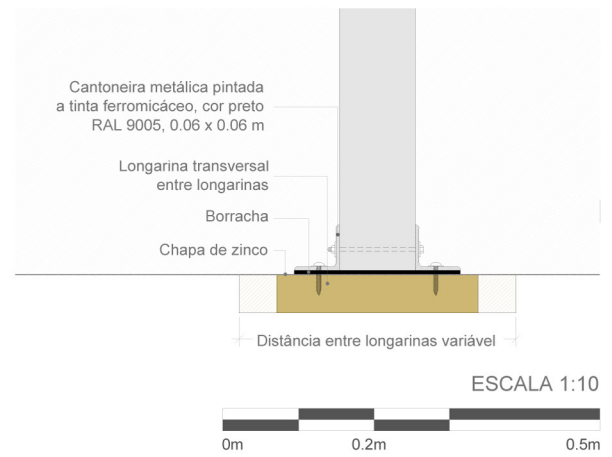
Localização e pormenorização construtiva da pérgula metálica.
